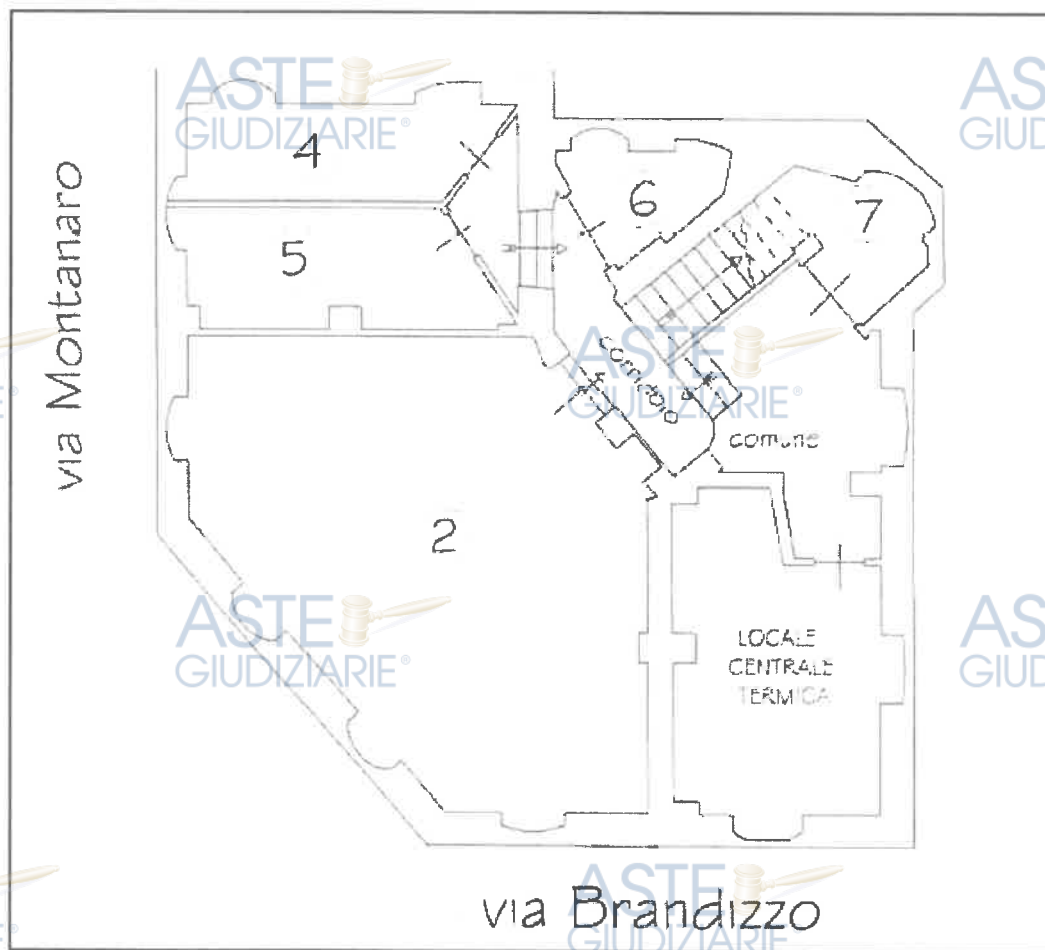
estratto planimetria piano interrato allegato al regolamento condominiale
